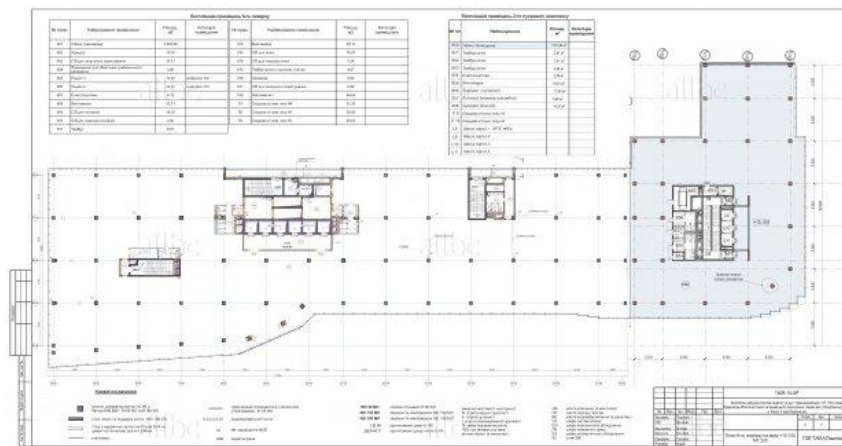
Планування 6-ого поверху БЦ Магнет [16]
